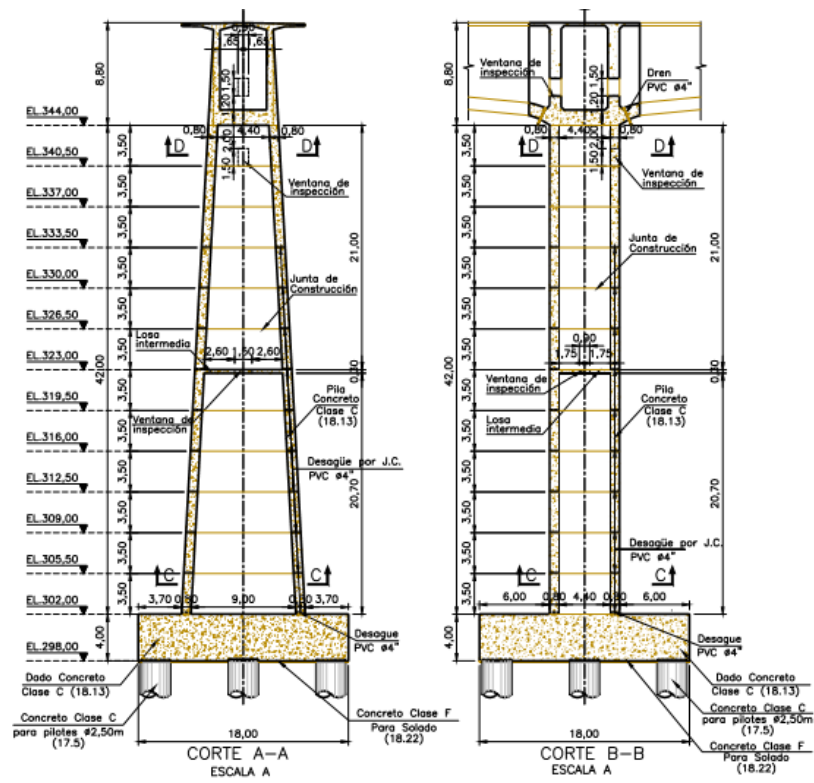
Puente Gómez Ortiz Plano Sección Longitudinal. ISAGEN
